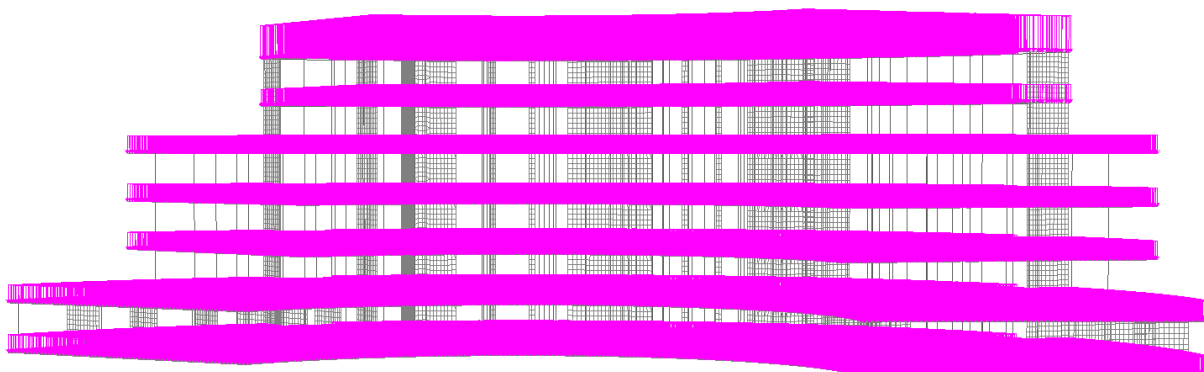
Схема приложения полезной нагрузки на перекрытия и покрытие.
